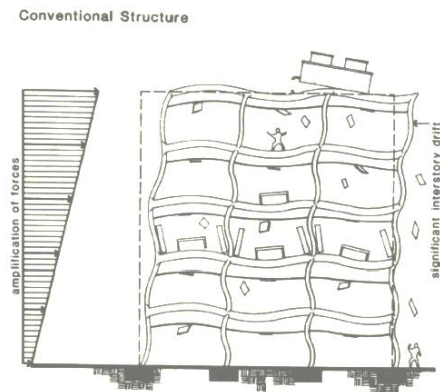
Sistem tumpuan terikat pada pondasi
